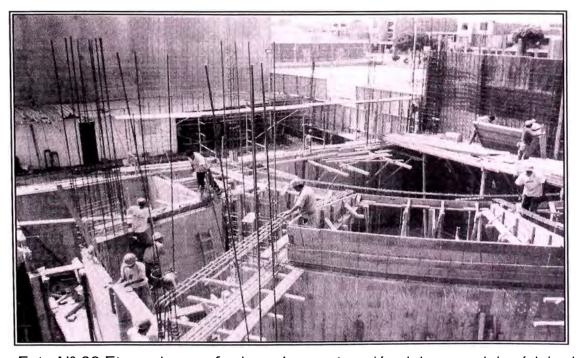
Etapa de encofrado en la construcción del casco del módulo de auditorio
